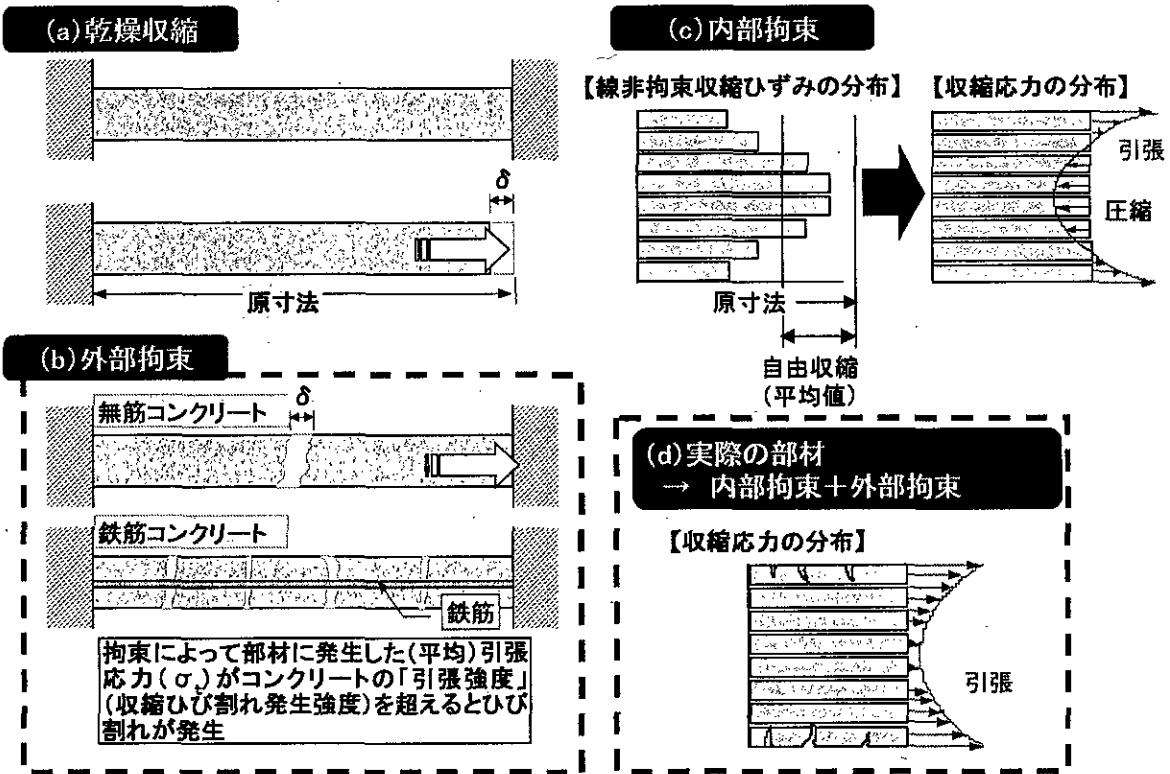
乾燥収縮ひび割れ発生のメカニズム
